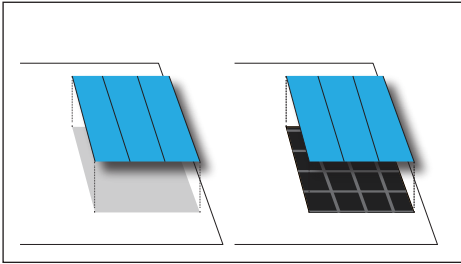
Aufdachmontage (links), das PV-Modul ist über der Dachfläche, Indachmontage (rechts), das PV-Modul ist in der Dachfläche angeordnet.
